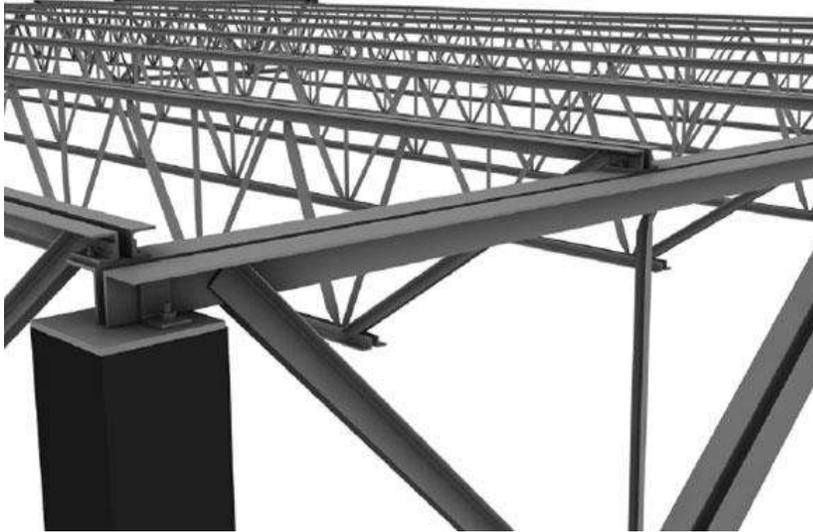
ESTRUCTURA JOIST FUENTE: [http://www.arquitecturaenacero.org/uso-y-aplicaciones-del-acero/soluciones-constructivas/steel-i-joist\(20-abril/2018\)](http://www.arquitecturaenacero.org/uso-y-aplicaciones-del-acero/soluciones-constructivas/steel-i-joist(20-abril/2018))
